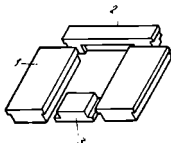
Крупноблочные наружные стены. Разрезка стен на блоки:
